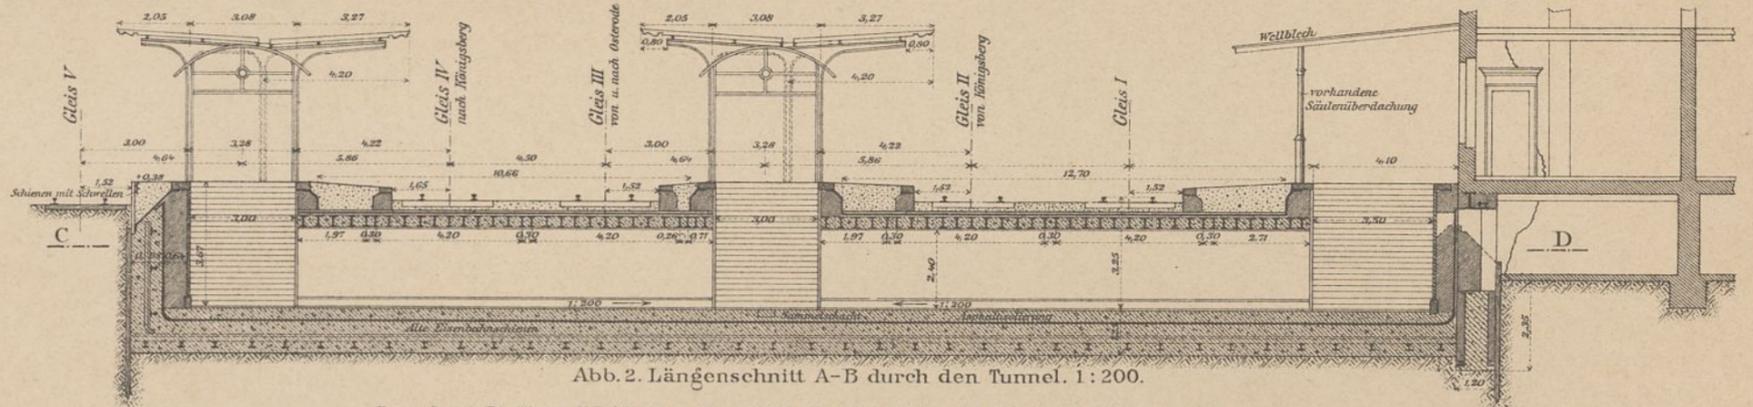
Längenschnitt A-B durch den Tunnel. 1:200.
